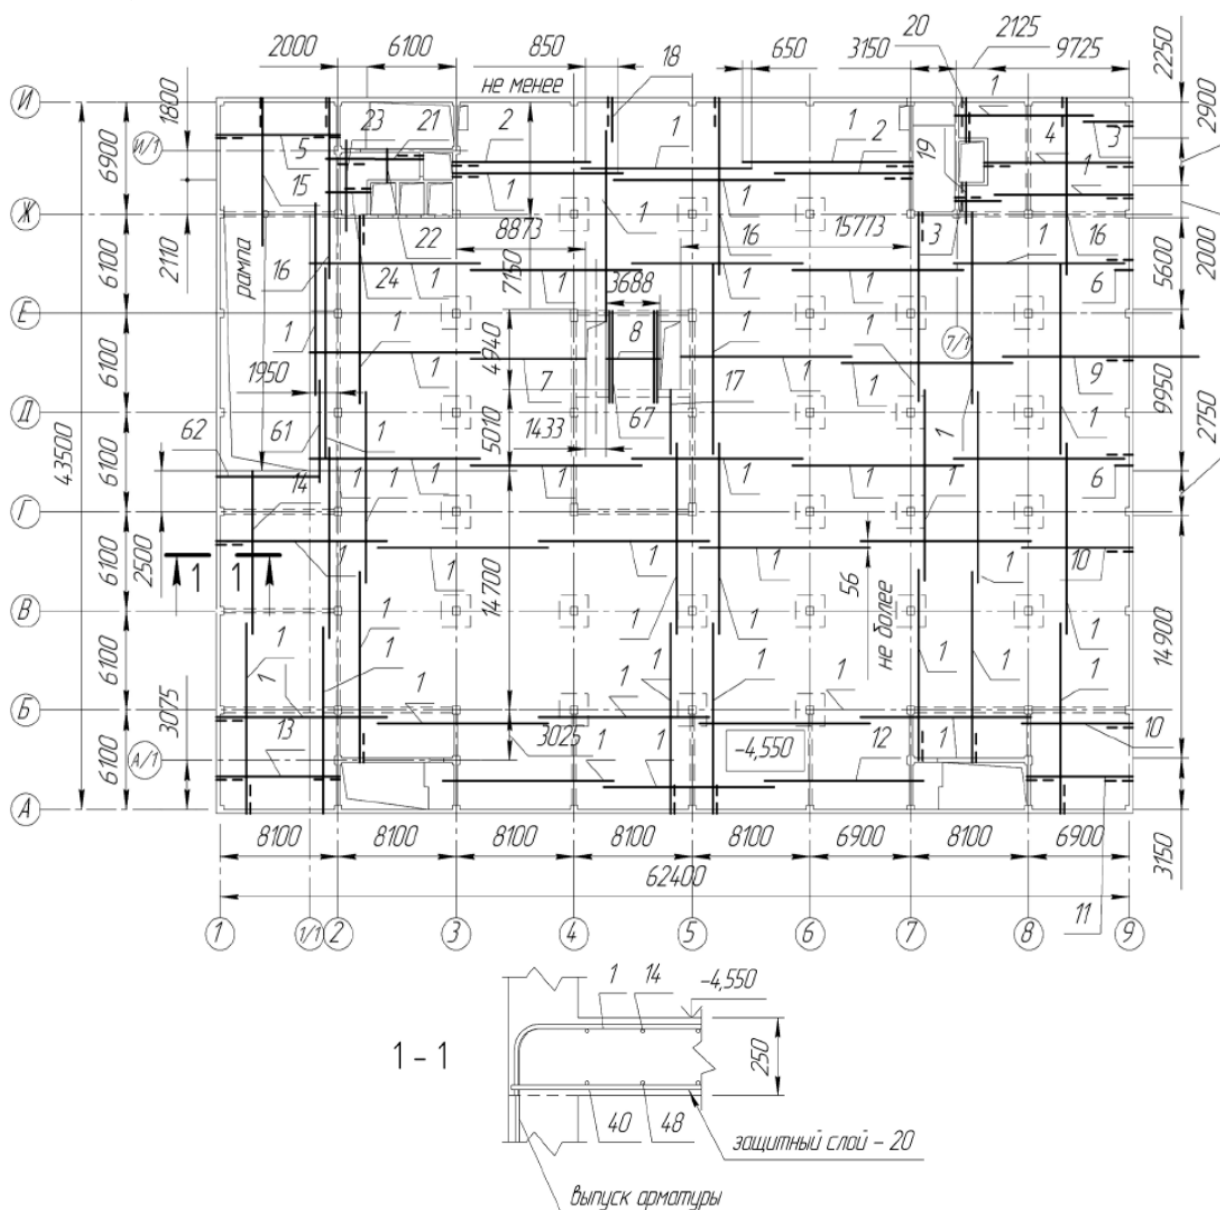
Схема армирования монолитной плиты перекрытия в здании с колонной конструктивной схемой
